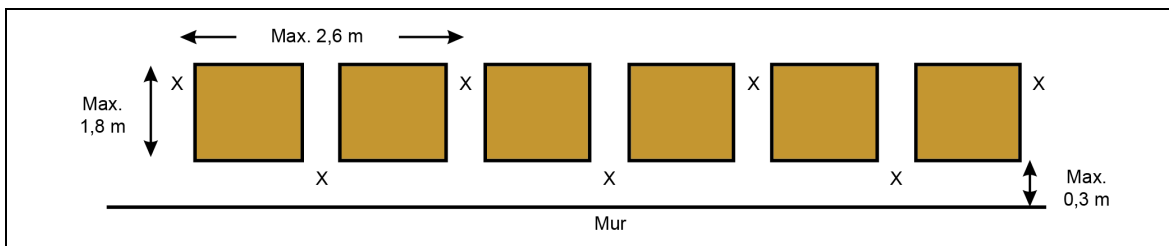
Vue en plan de l'agencement alternatif des sprinkleurs dans des casiers simples mesurant jusqu'à 1,8 m de profondeur et situés contre un mur
